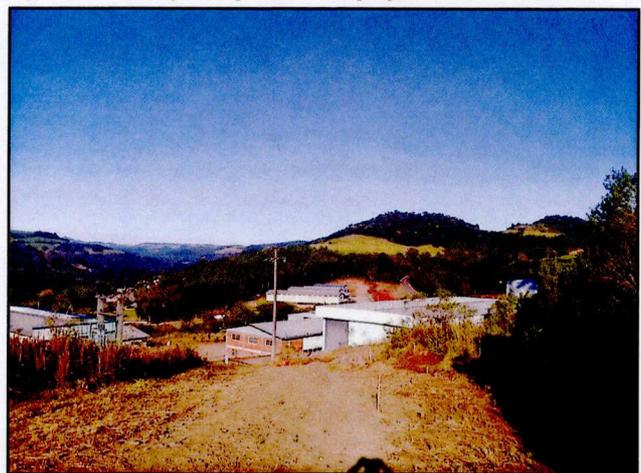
vista sul do leito da Rua existente a ser regularizada, conforme ponto 02 do projeto;
